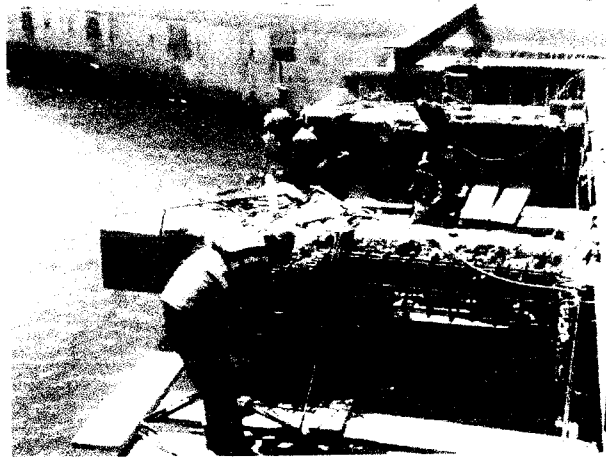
Reparación de vigas cabezales en puente de acceso al muelle. Obras de mar
